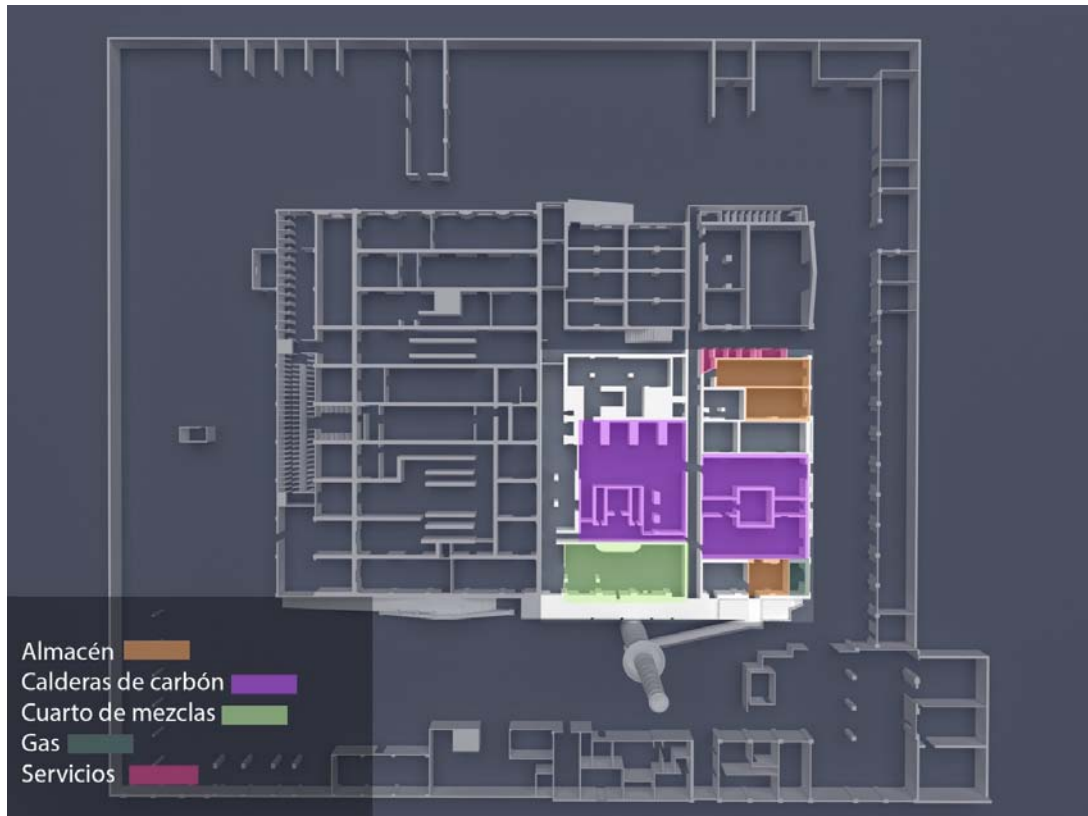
Distribución en planta (Planta Baja (nave2))
